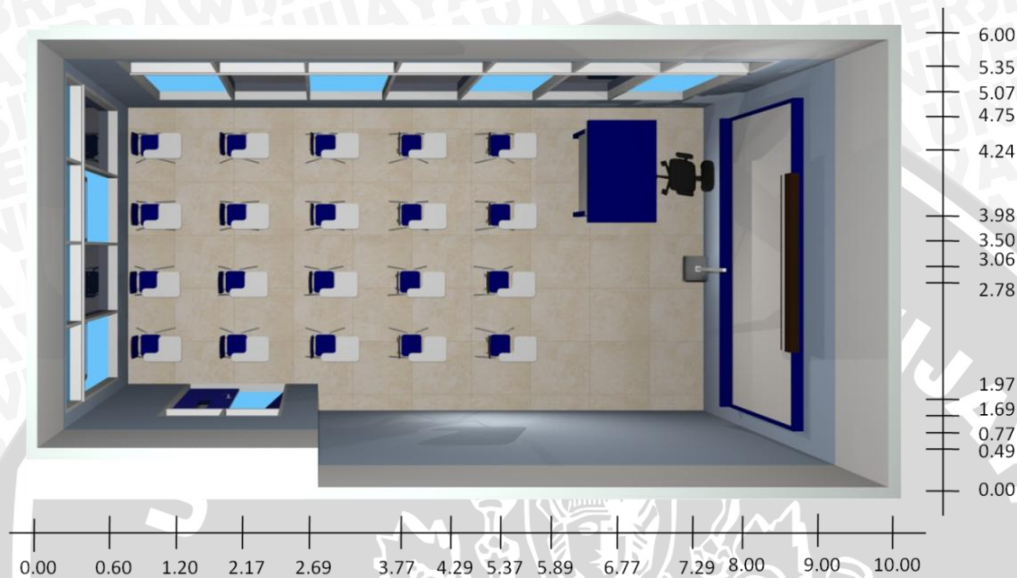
Eksterior dan Interior Ruang Kelas Hitungan
